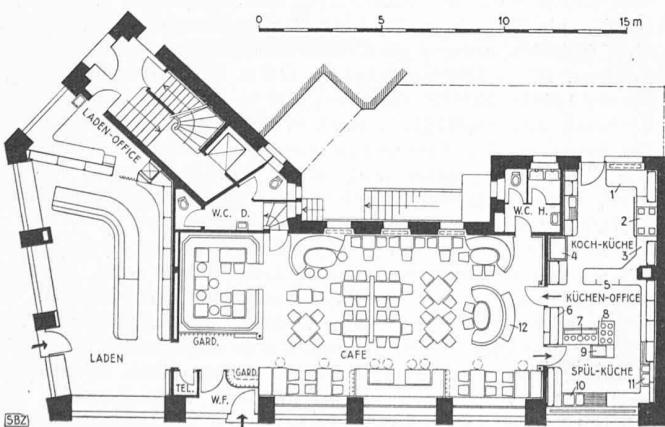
Grundriss 1:300. Legende: 1 Rüsten, 2 Kochen (bestehend, 3 Anrichten, 4 Kühlschrank, 5 Wärmeschrank, 6 Getränke, 7 Kaffeemaschine, 8 Glace, 9 Reg.-Kasse, 10 Gläserspül, 11 Geschirrspül, 12 Besteck. -- Laden siehe Seite 126
